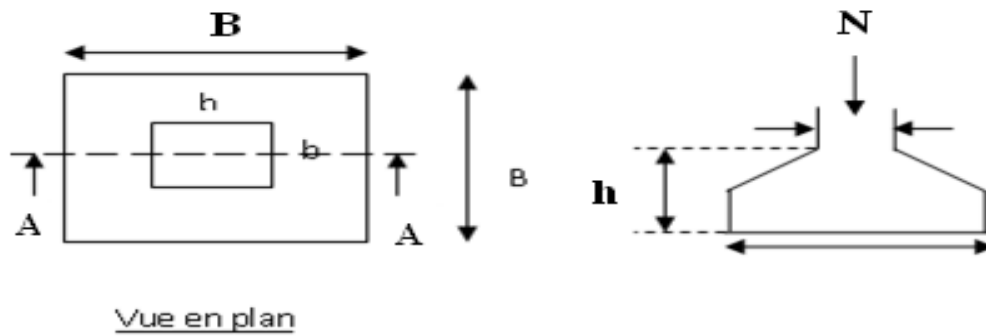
schéma de la Semelle isolée de fondation.
